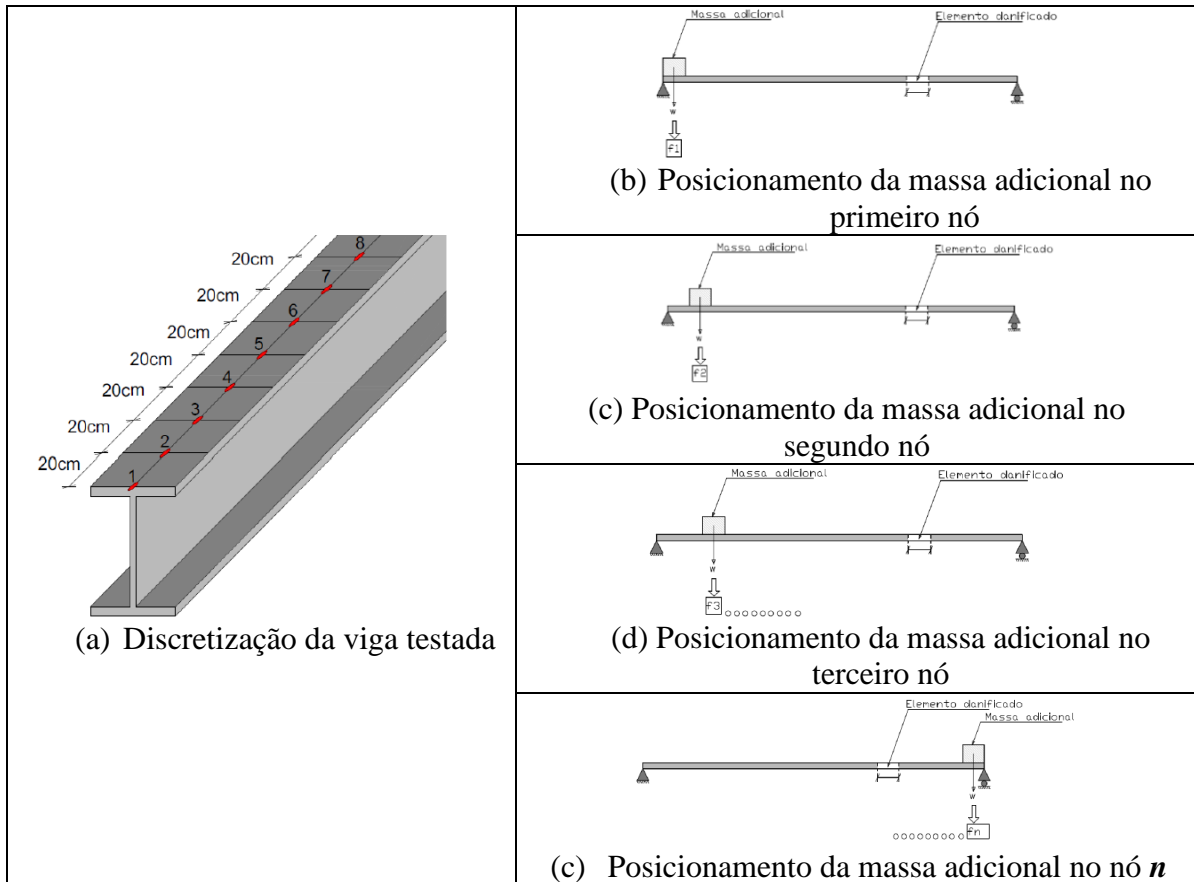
Panoramas da viga testada (Palechor, 2018)
